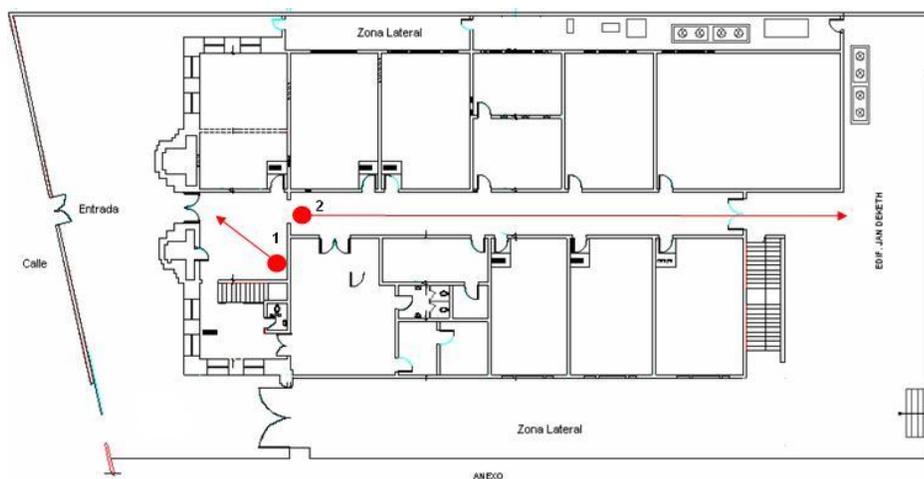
Ubicación de cámaras entrada edificio Arvelo planta baja
